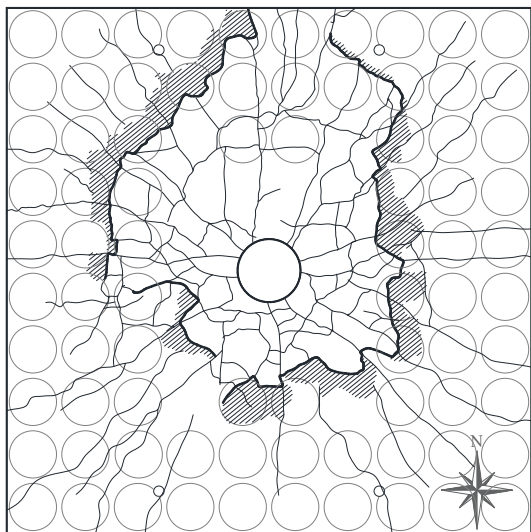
Mapa de fissuração da laje BD2
